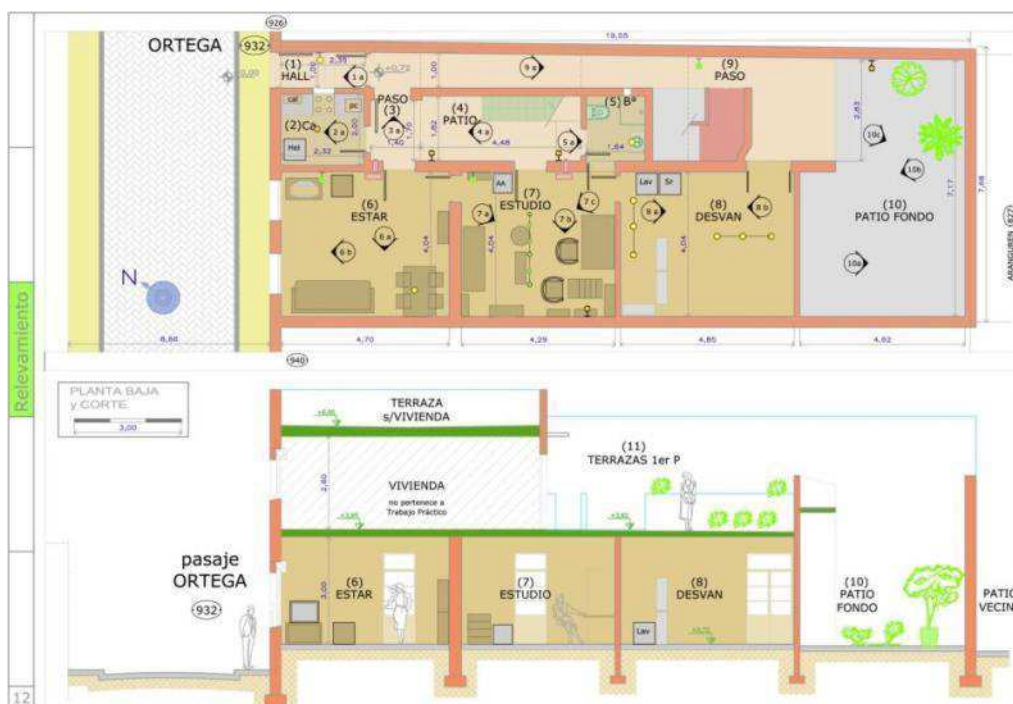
“Planos de Relevamiento de la Planta Baja”. Fuente: las autoras
